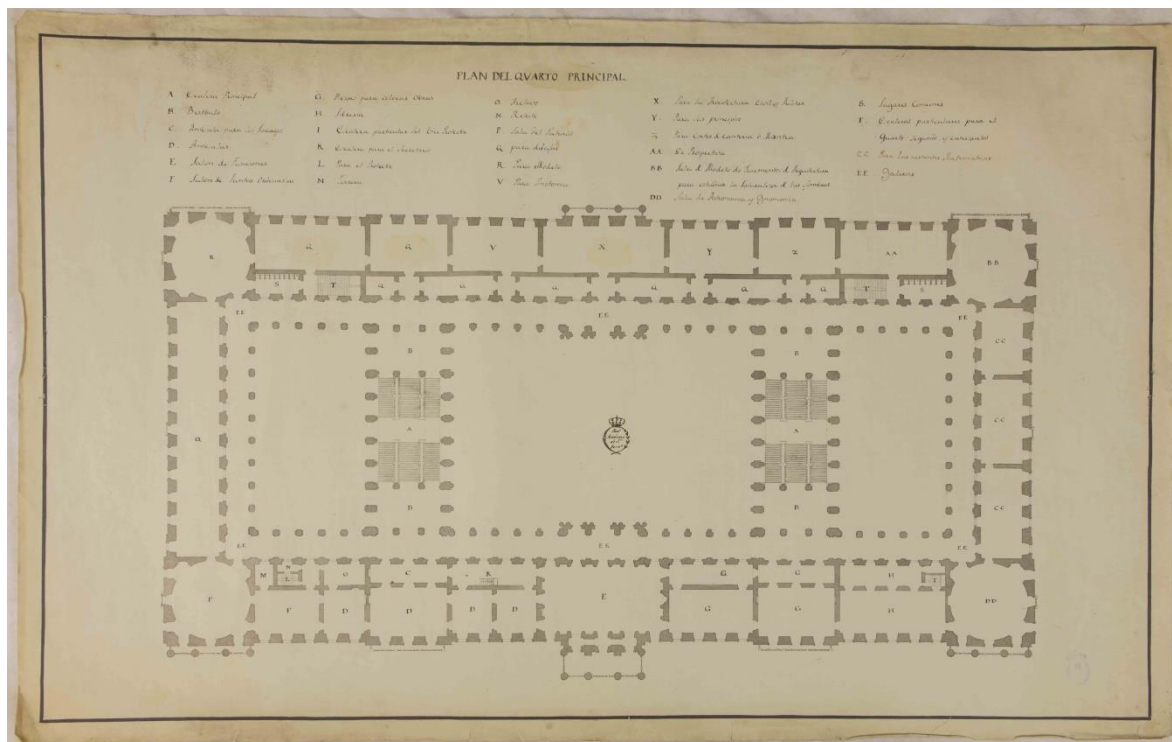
Dibujo A-258: Planta general, Archivo R.A.B.A.S.F.
